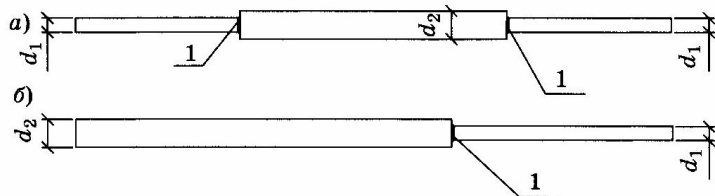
Составные отдельные стержни: *a* - для применения в балках; *б* - для применения в колоннах, опорных стенках и т.п.; 1 - контактная стыковая электросварка
